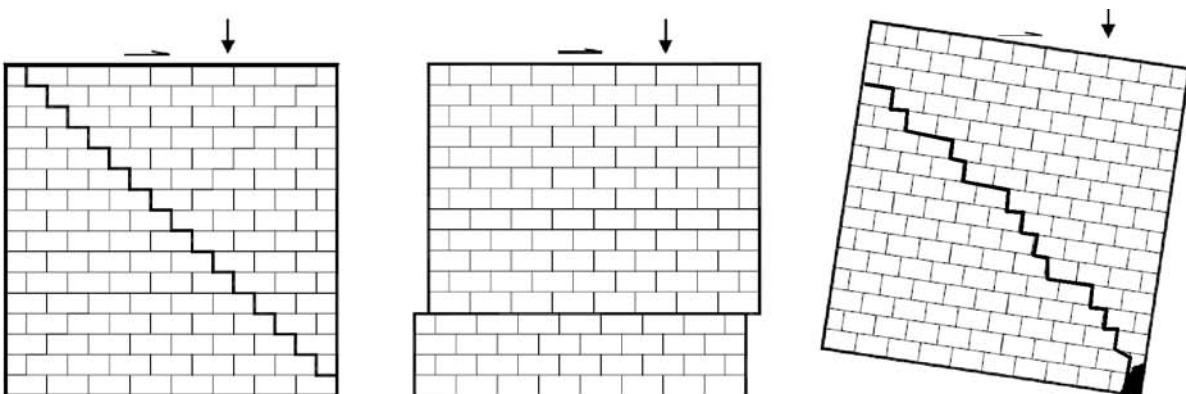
Spröde Versagensformen von Mauerwerk unter horizontaler Beanspruchung
